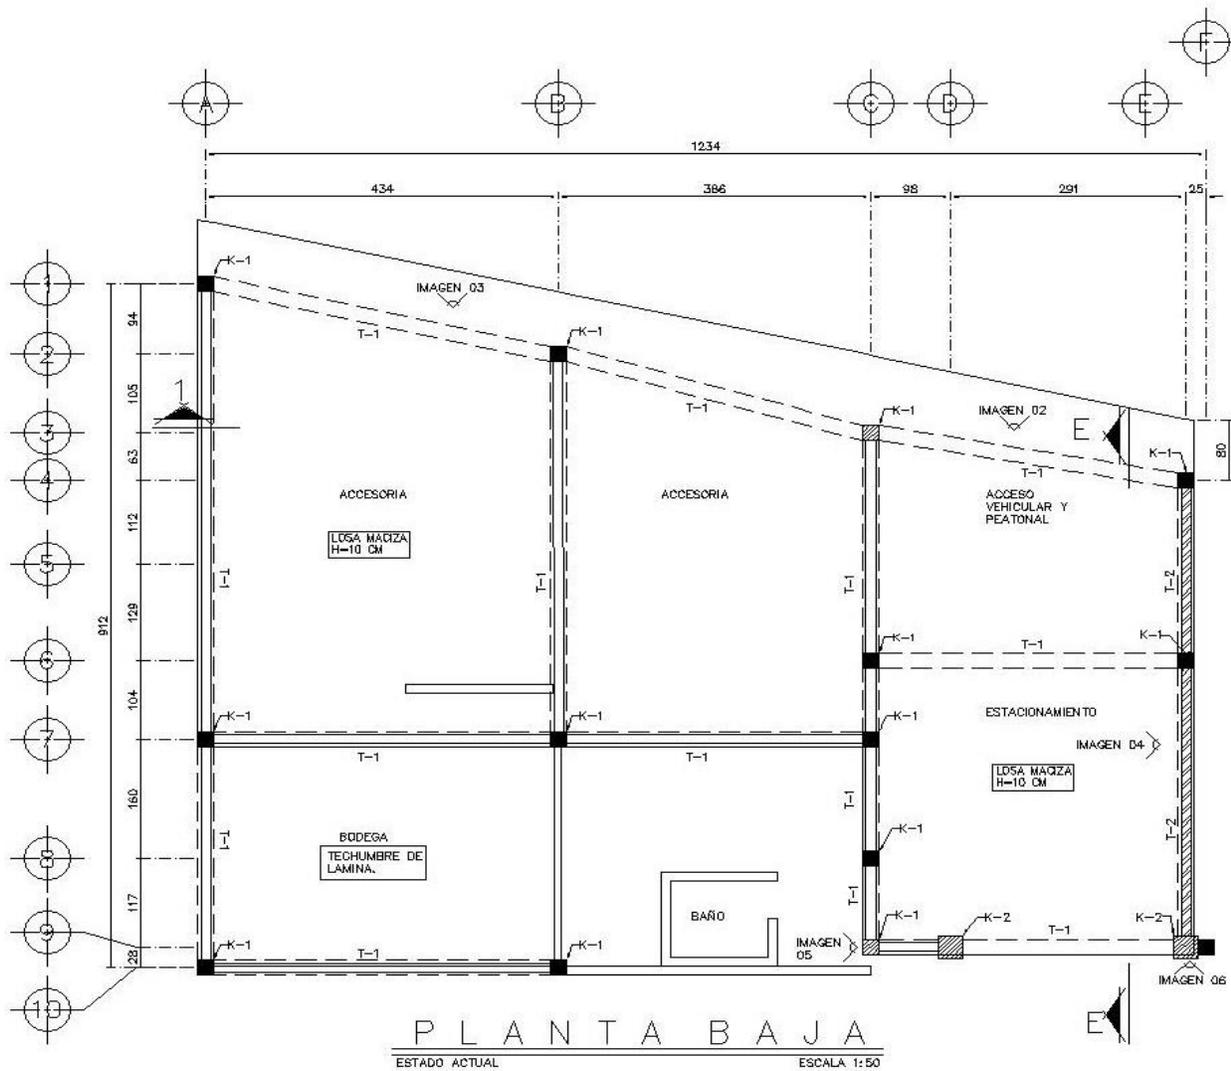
Estado Actual de la vivienda planta baja.
